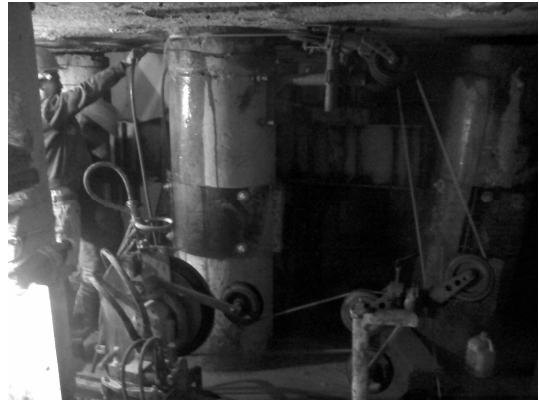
Se muestra el proceso de corte de pilotes bajo las zapatas de cimentación
